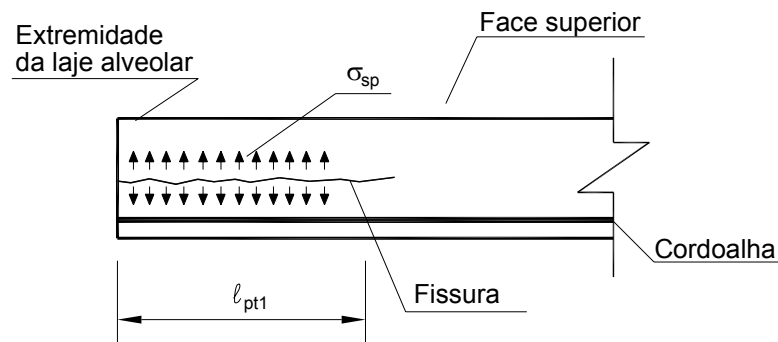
Fissuração longitudinal devida ao fendilhamento do concreto nas nervuras.
